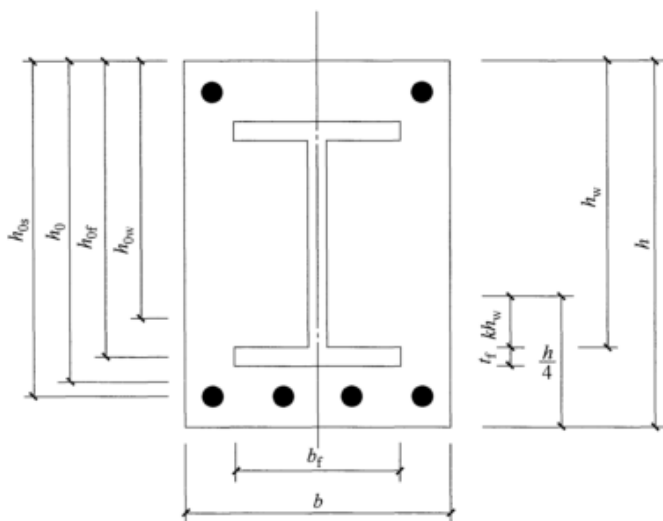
活性粉末混凝土加固型钢梁最大裂缝宽度的计算示意图
